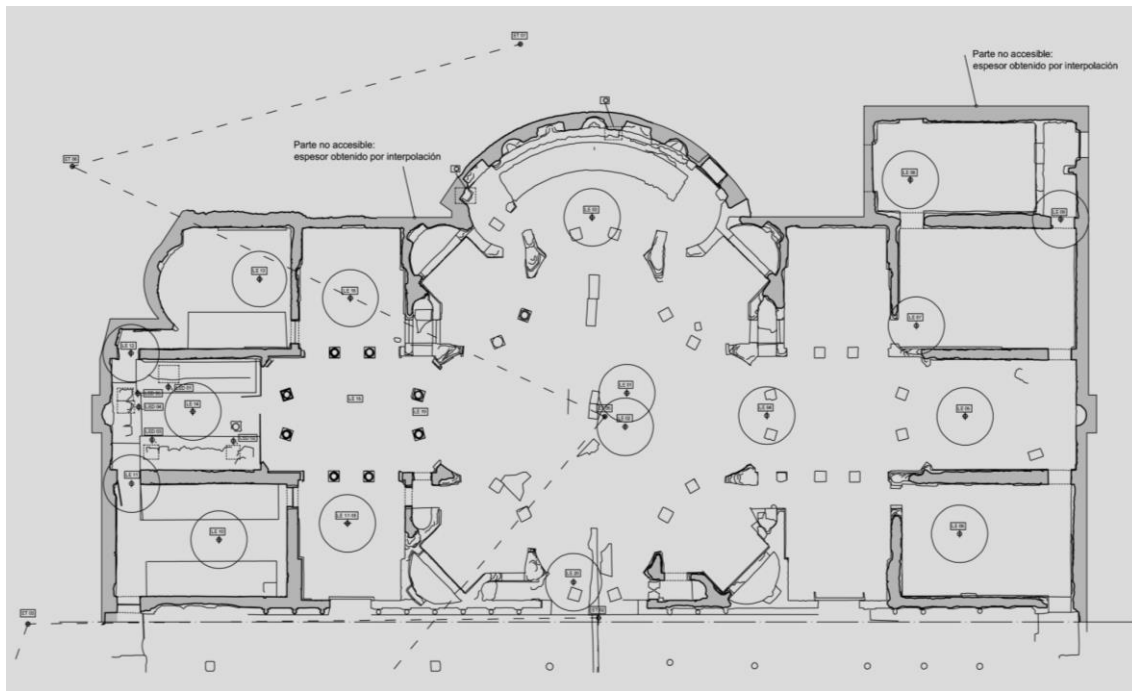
“*Screenshot*” de la planta proyectada sobre el plano de cota cero.
